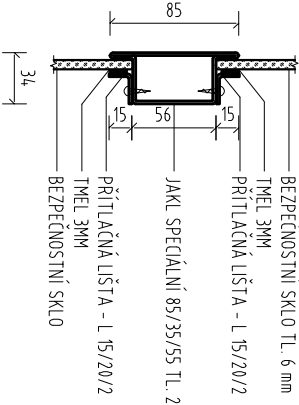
DETAIL NAPOJENÍ VÝTAHOVÉ KONSTRUKCE 1:5
